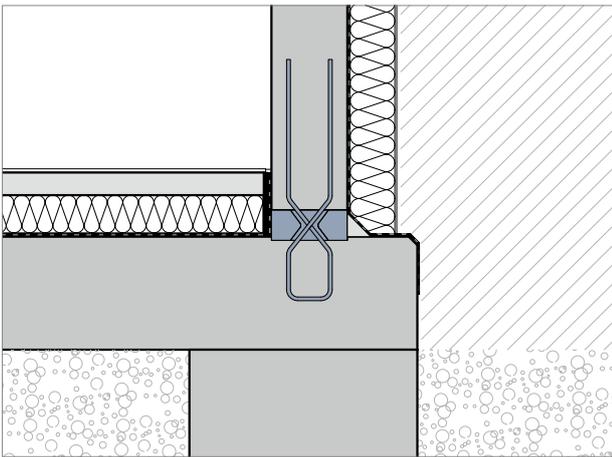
Schöck Sconnex® type W mur extérieur sur semelle filante/barrière antigel
